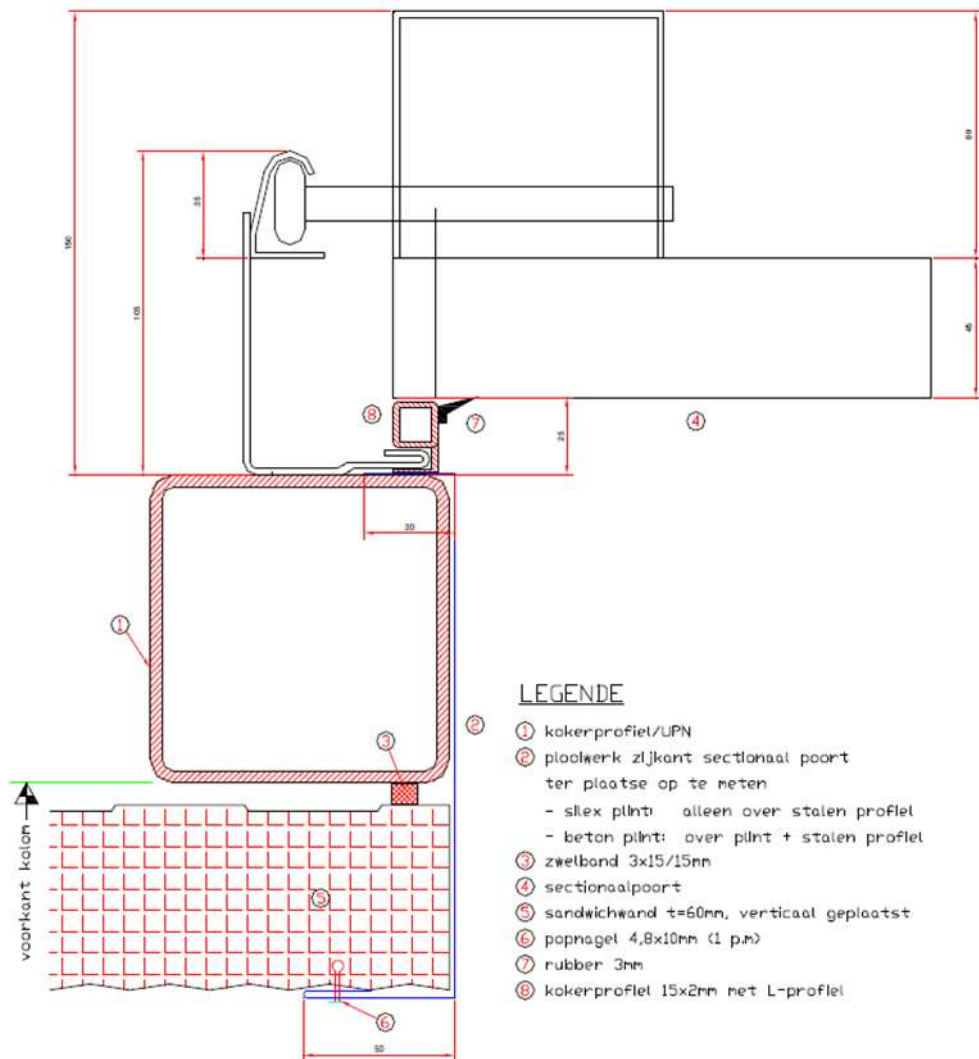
Innovatief inbouwsysteem voor sandwichpanelen.³⁹
